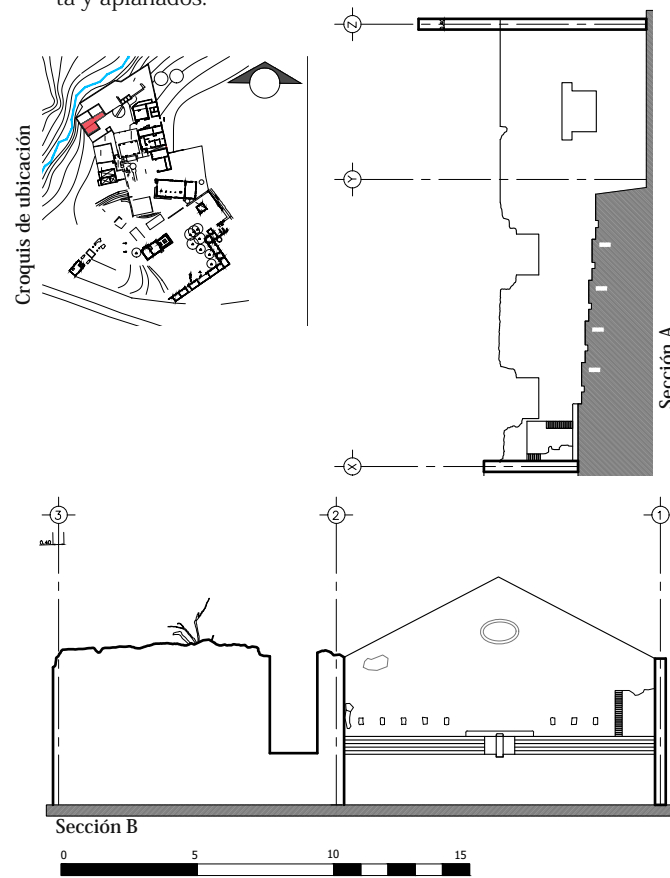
Planos del levantamiento arquitectónico del estado actual.
